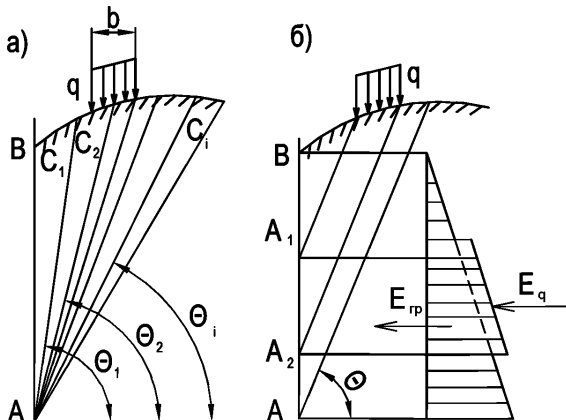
К определению активного давления песка или супеси на стенку ограждений при произвольном очертании поверхности грунта и расположении на ней нагрузки
